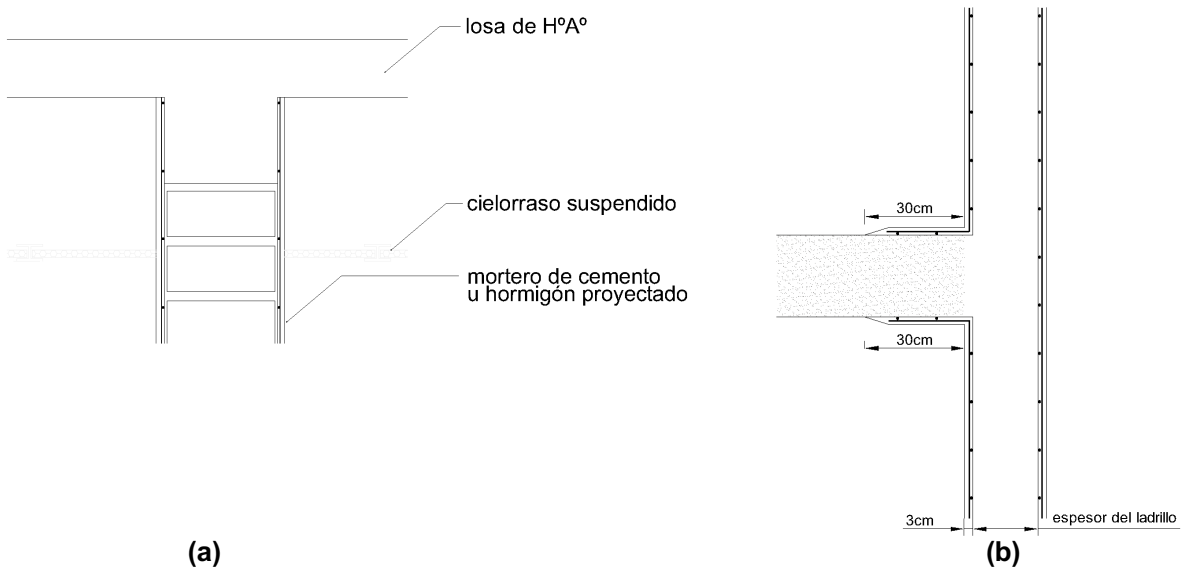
(a) Vinculación de mallas a vigas existentes. (b) Vinculación entre muro sin reforzar y muro reforzado
